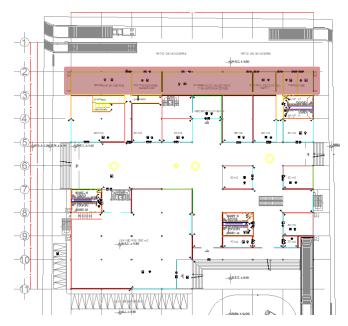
Ubicación en el plano de zona de servicios generales privados en Planta Baja. Fuente: Elaboración propia.
